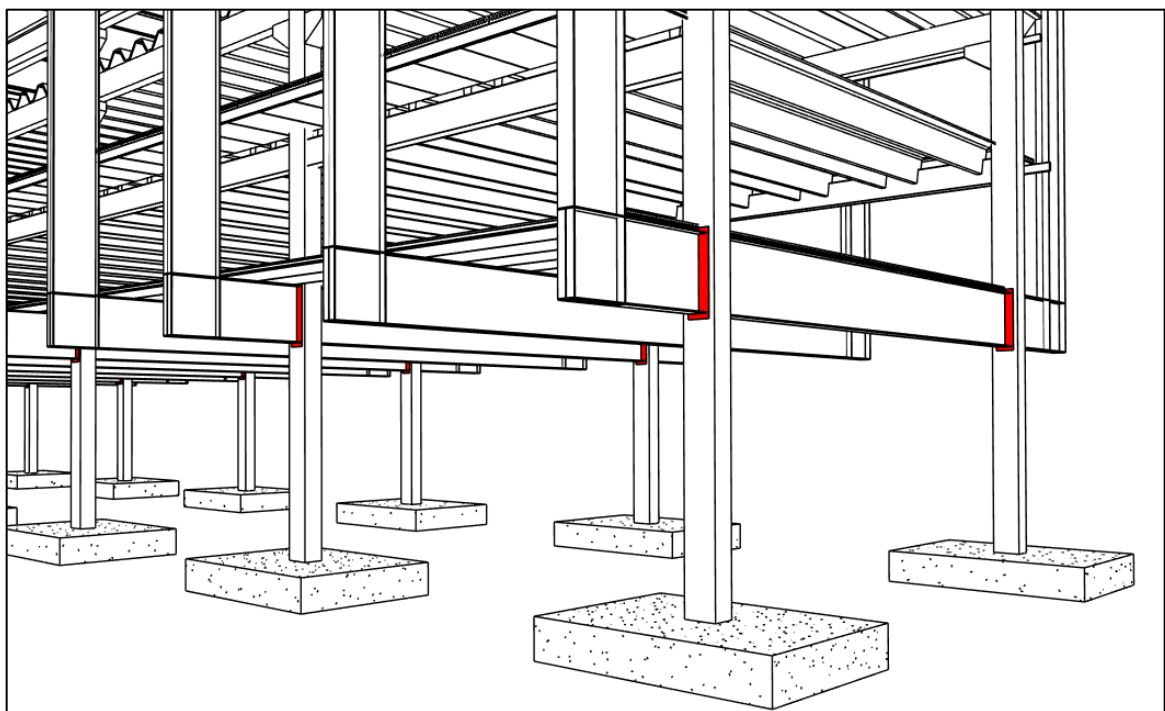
Ubicación de uniones entre vigas y columnas. Fuente: Autor.
